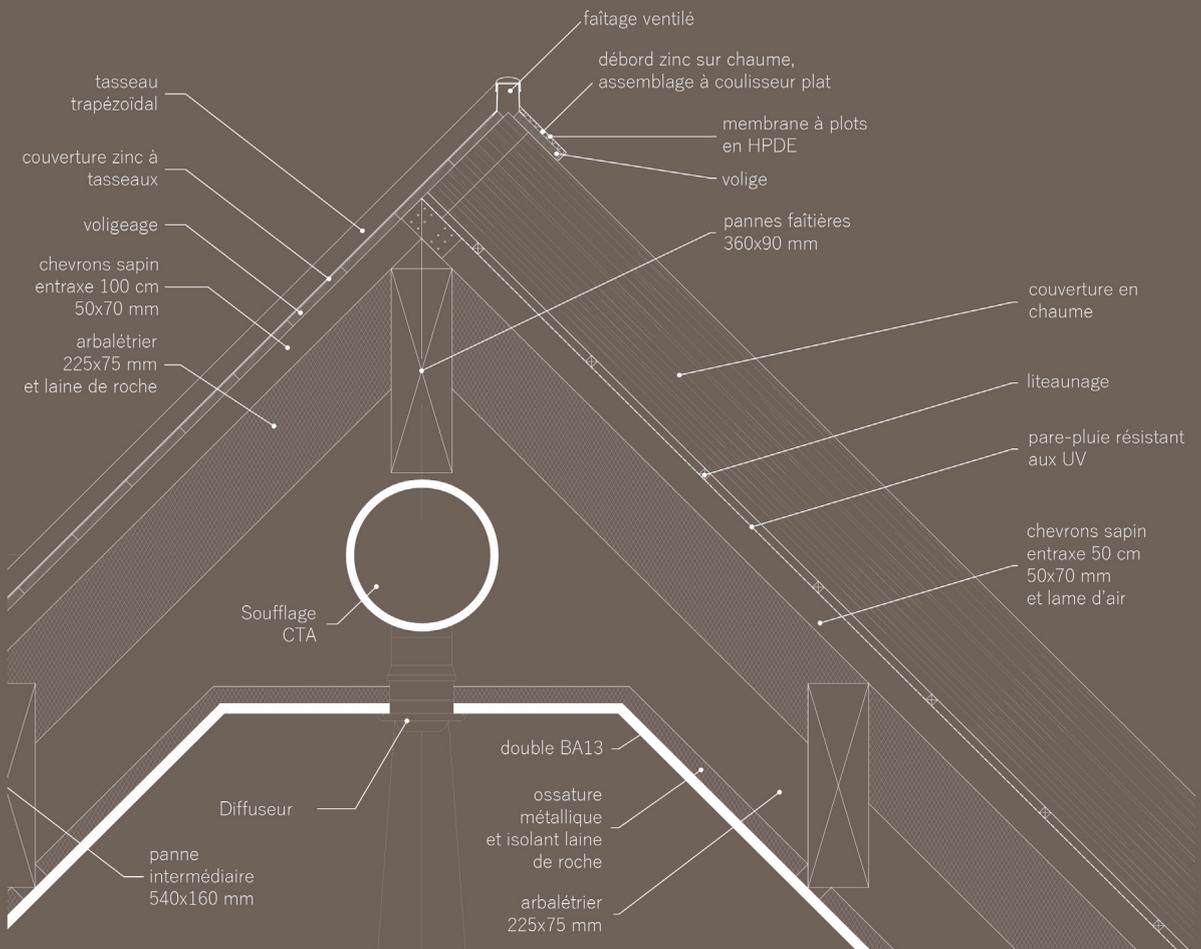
Détail technique raccord toiture chaume/toiture zinc. Crédit CoBe
